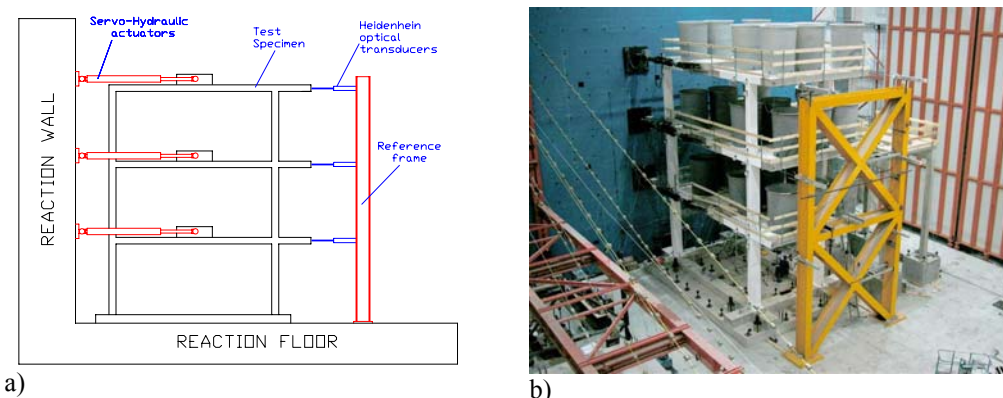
a) Dispositivo de ensaio e b) vista geral do modelo e do dispositivo de ensaio
